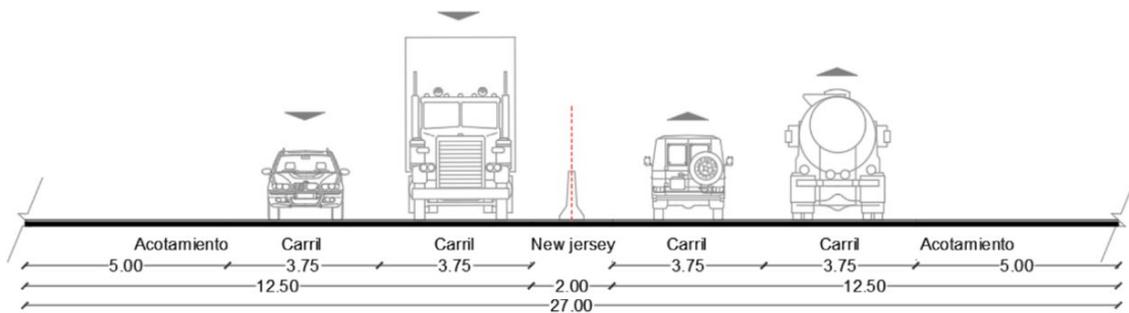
Distribución metros de carretera Guadalajara- Ocotlán/ Sección A-A
